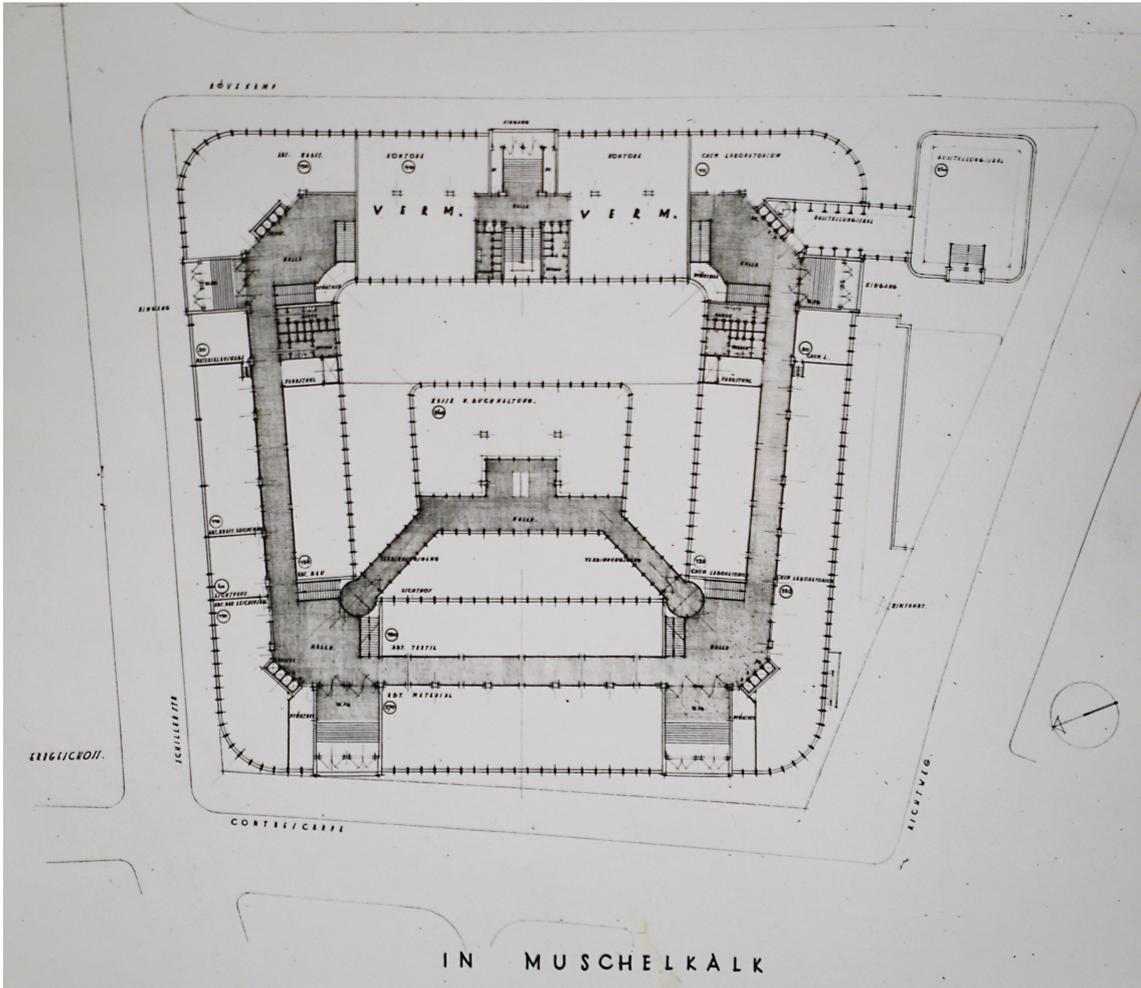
Grundriss Erdgeschoss für Wettbewerbseingabe, 1927
